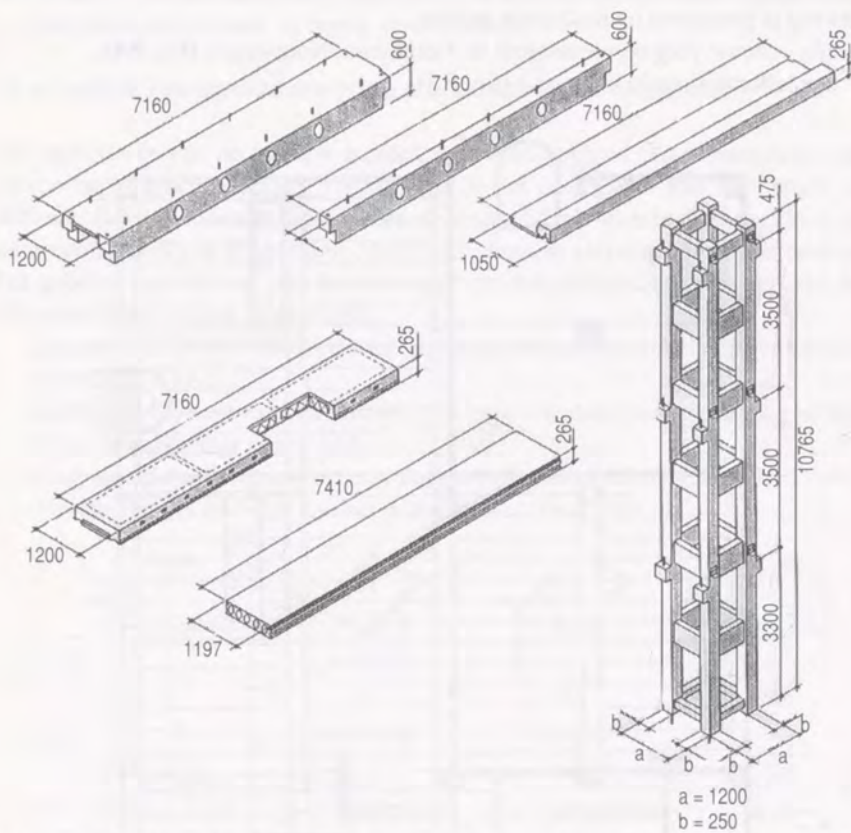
Geprefabriceerde betonnen componenten voor een laboratorium in Duitsland
